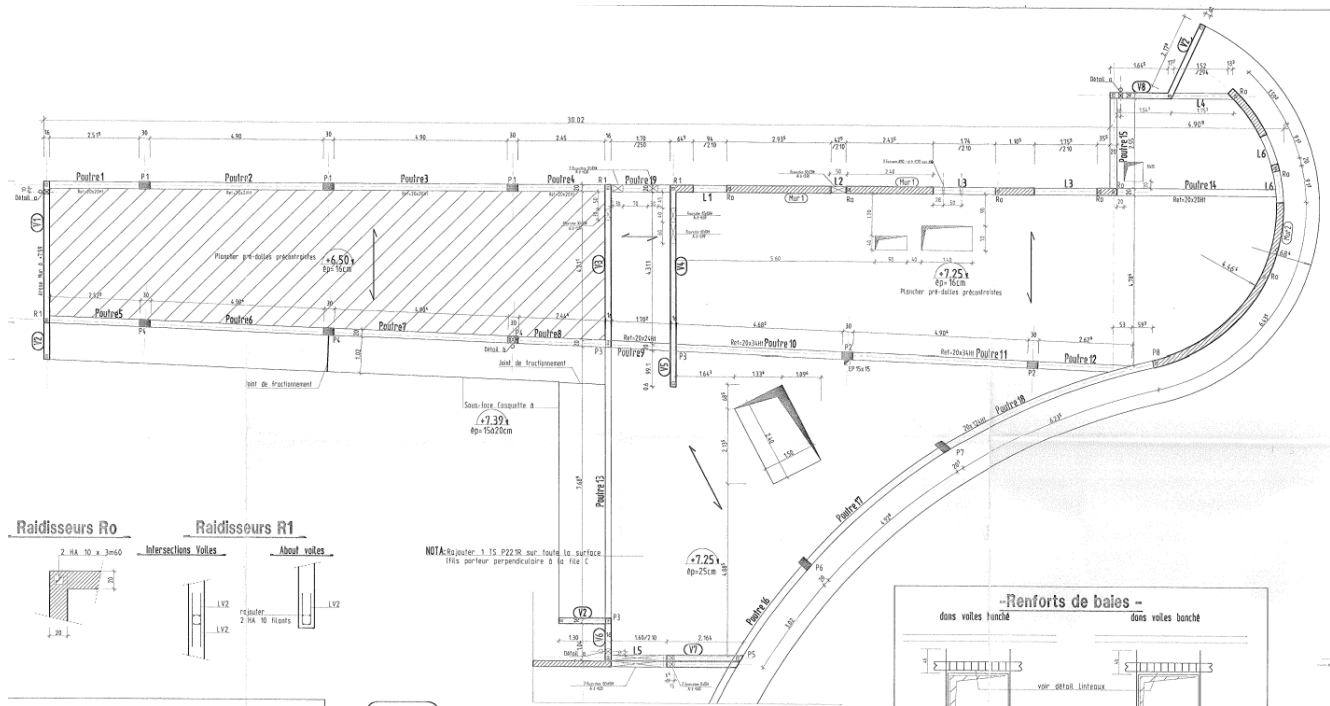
Extrait Coffrage Etage R+1, zone Nord / Plan SERBA 96.158 – EXE17B
